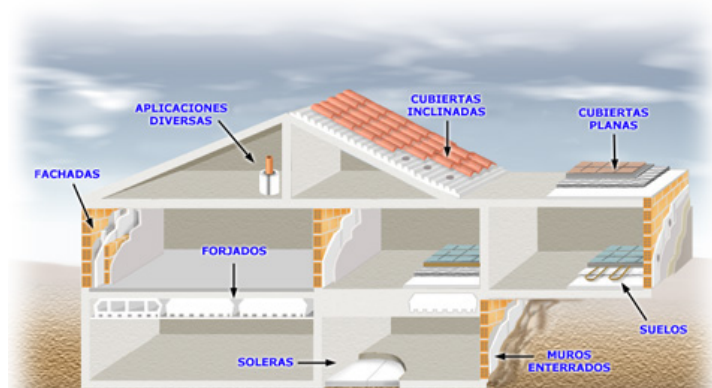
Aplicaciones del EPS en construcción. ANAPE
